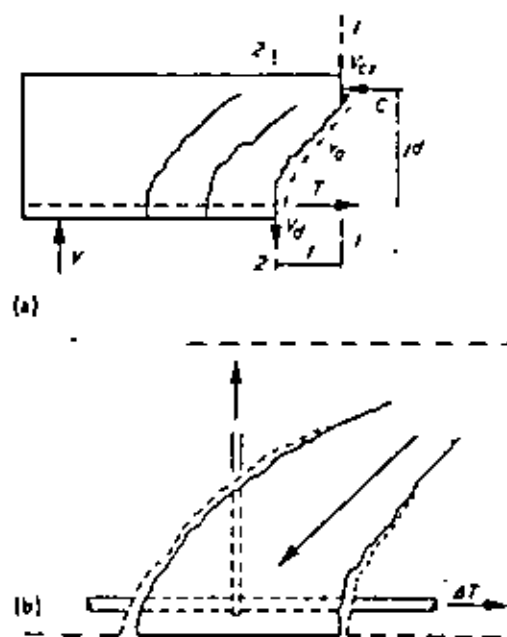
Mecanismo resistente al cortante en la viga. a) Las fuerzas internas resisten el cortante, sin que exista refuerzo en el alma, b) voladizo en el concreto que actúa como puntal, con la existencia de refuerzo en el alma.
